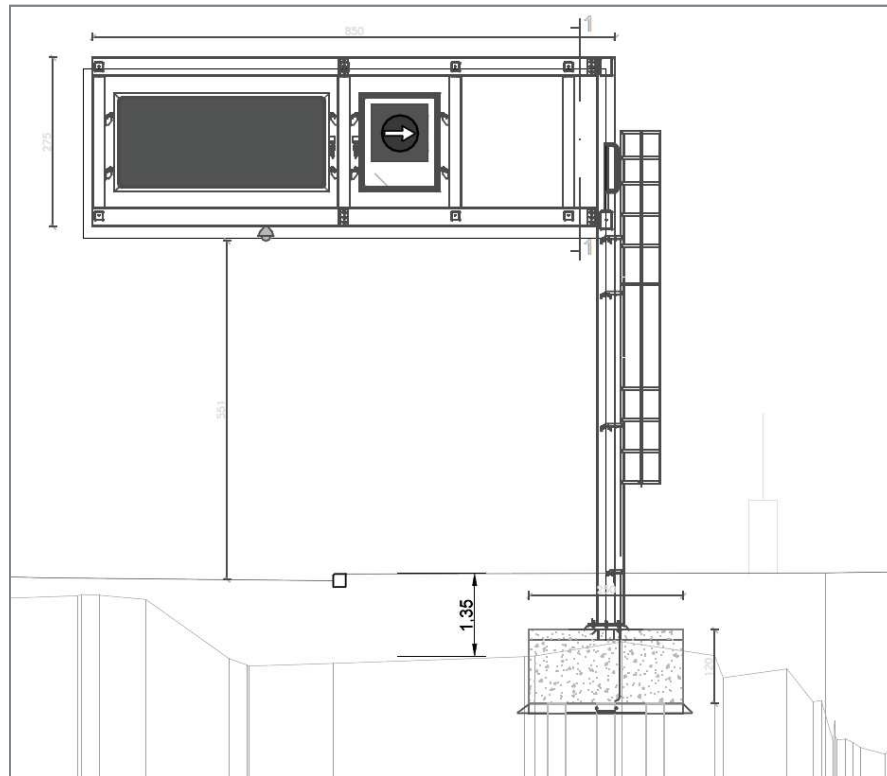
Schema del sistema PMV-fondazione – Sezione tipo lato Umbria
